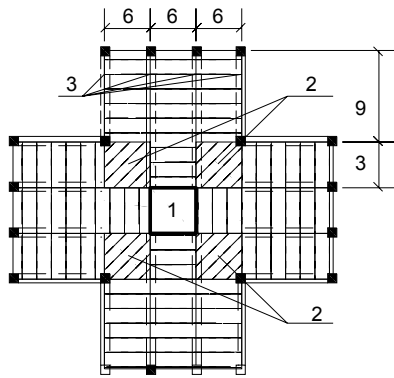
Конструктивний план багатоповислового каркасного будинку з центральним ядром жорсткості: 1 – ядро жорсткості; 2 – монолітні ділянки; 3 – ригелі
